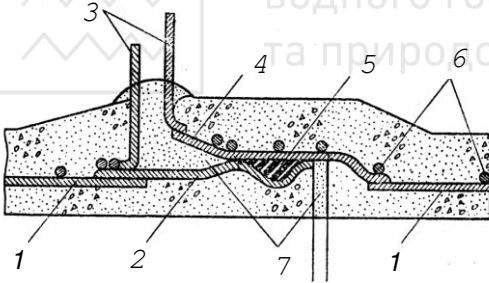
Розтрубне з'єднання залізобетонних труб із сталевим осердям:
